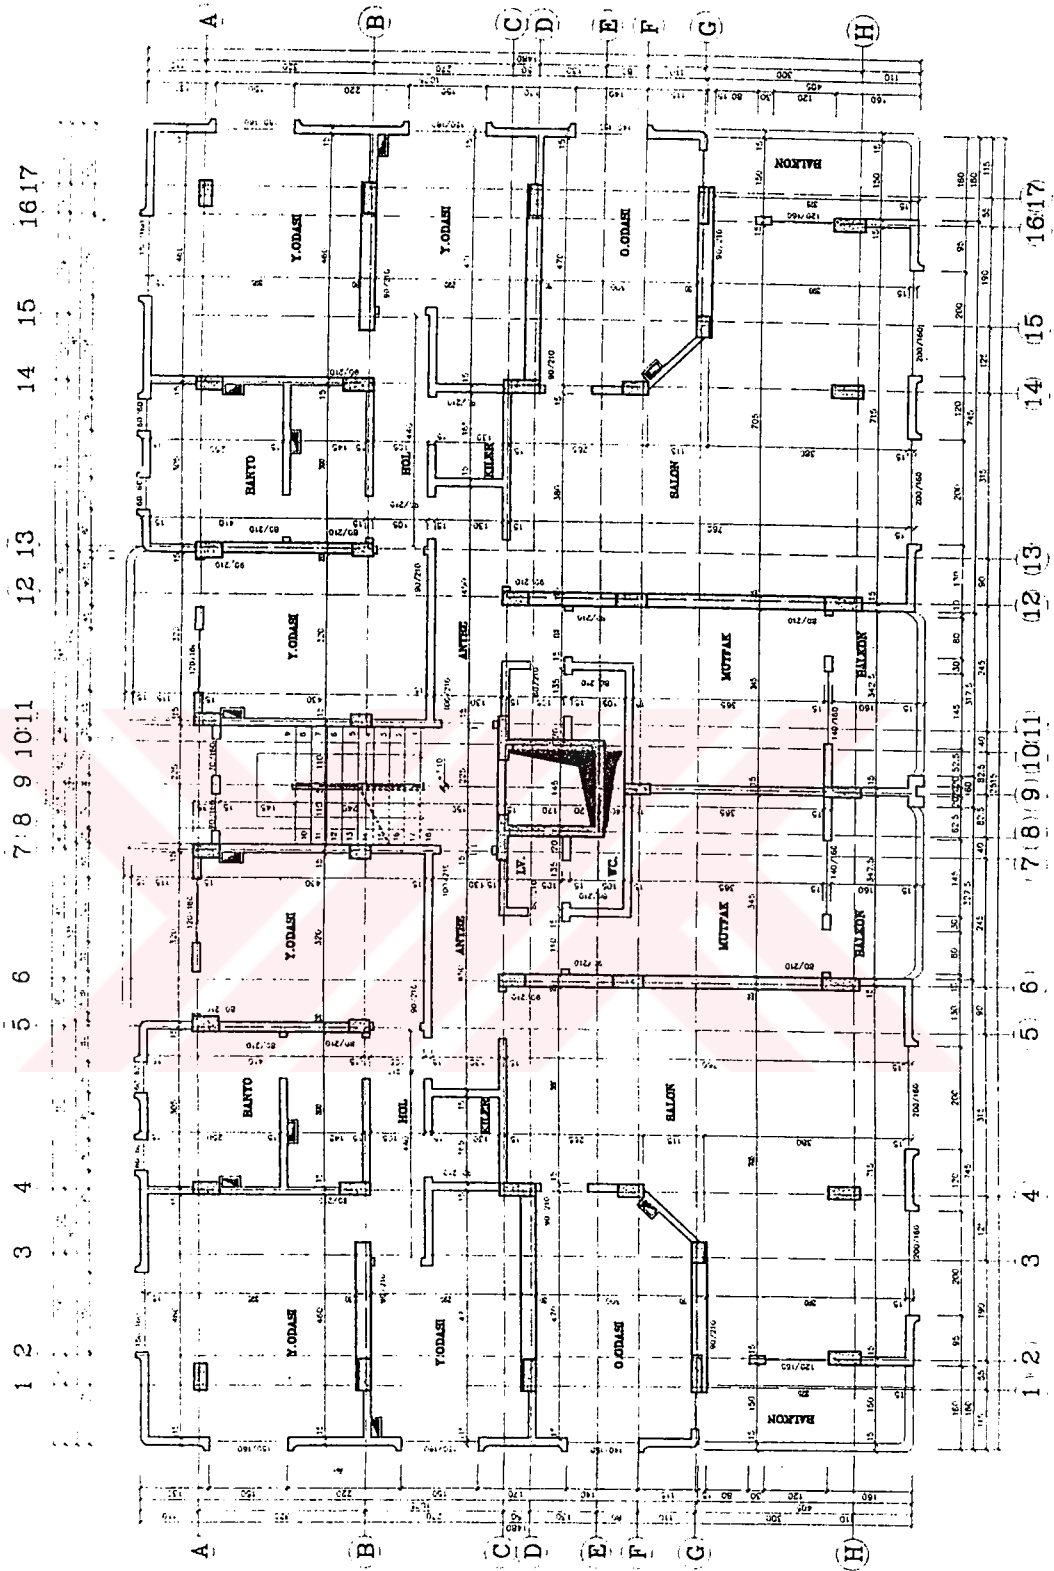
Orta hasar raporlu Aydızt Apartmanı 1. kat mimari röleve planı (Ölçeksiz).⁷
